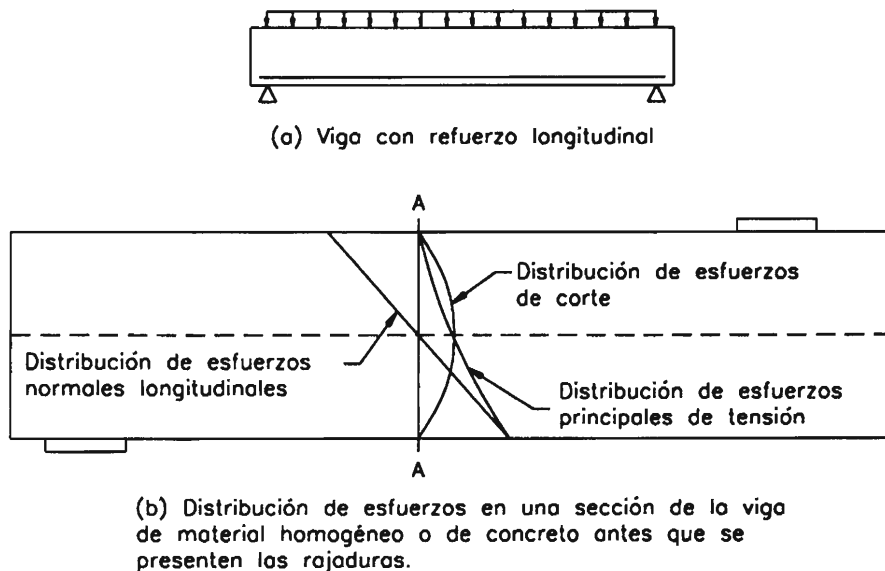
Viga simplemente apoyada sometida a carga uniformemente repartida y distribución de esfuerzos en la sección A-A
